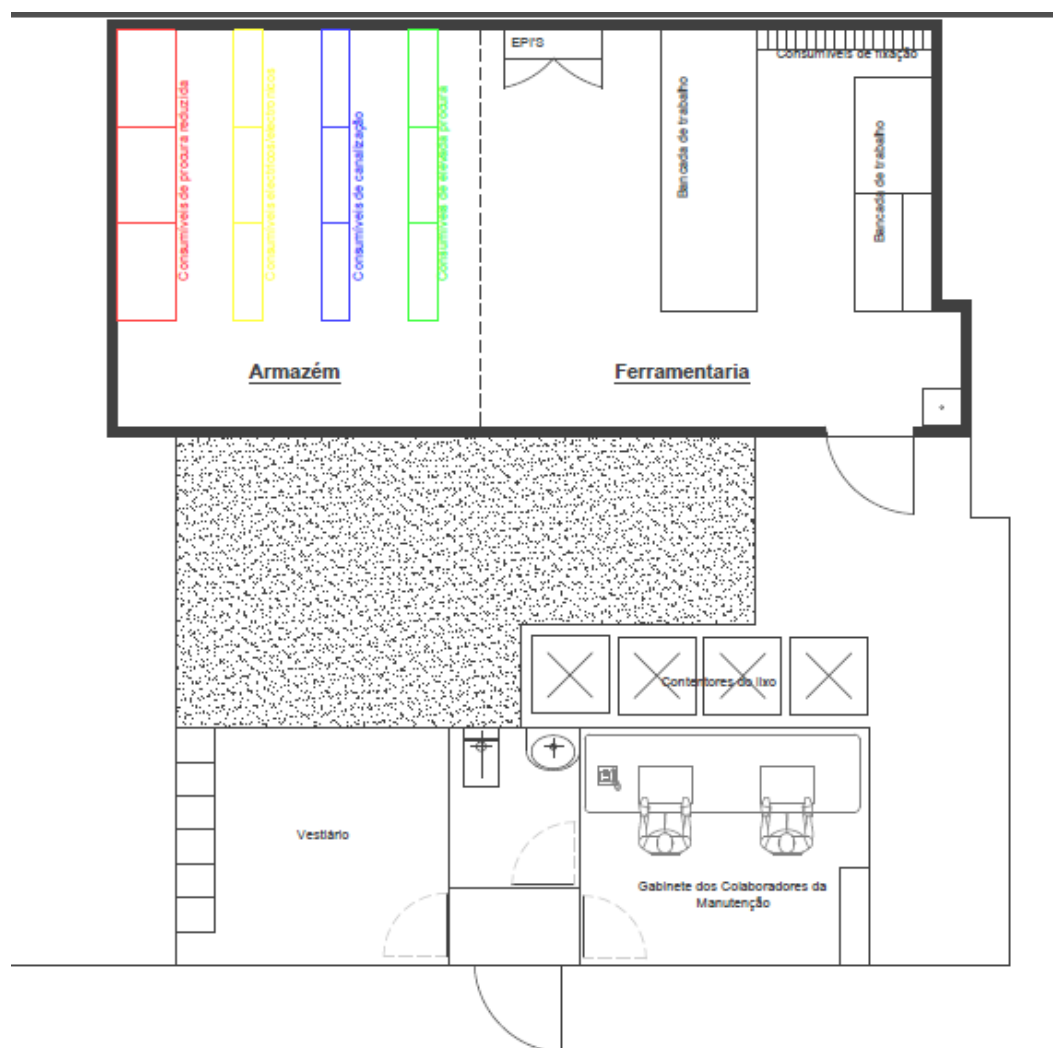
Layout do Armazém/ferramentaria do Serviço de Manutenção
